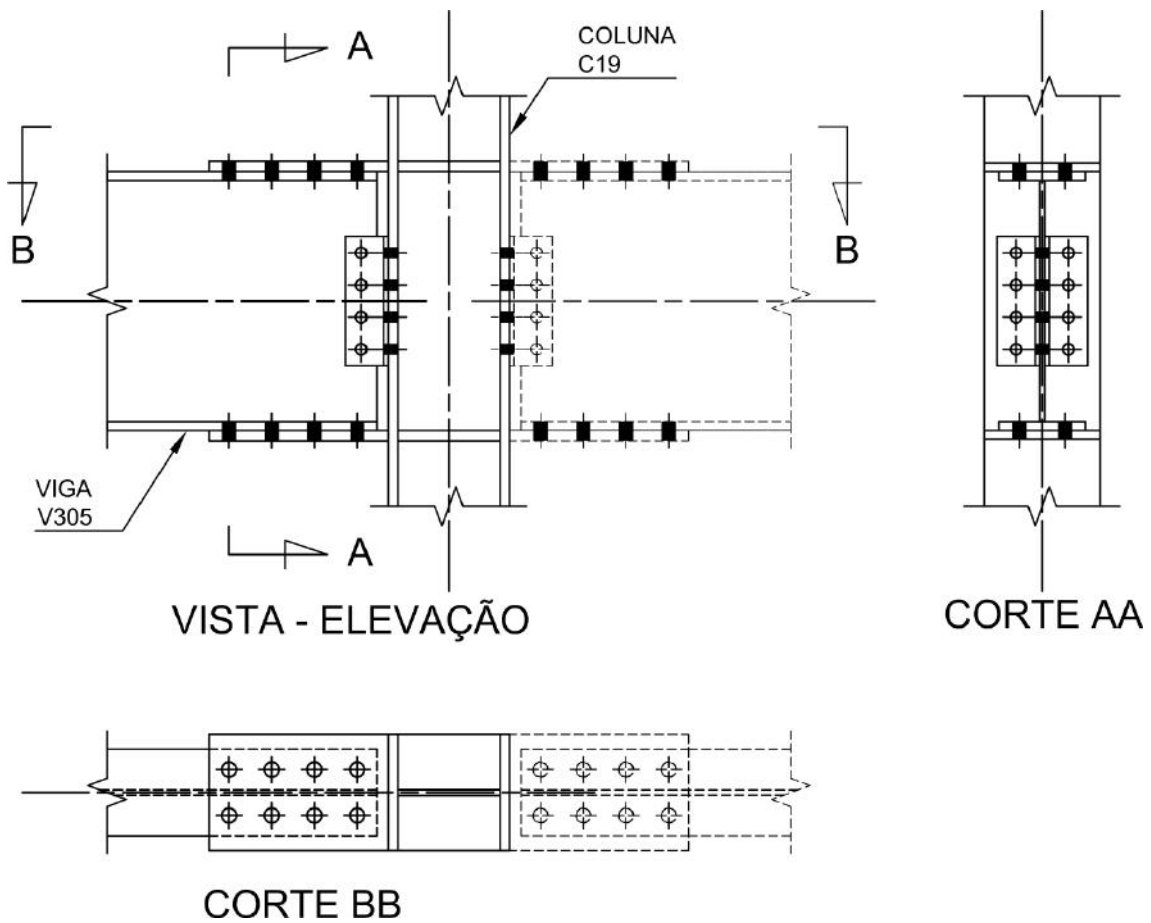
Geometria da ligação viga-coluna (V305 – C19)
